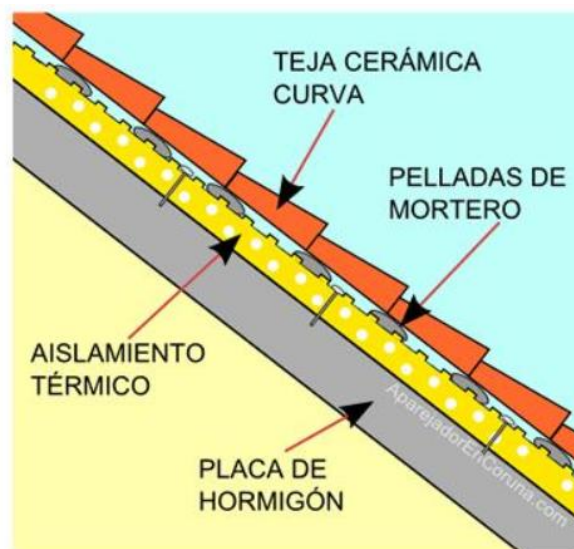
Aislamiento térmico en cubierta inclinada. Fuente: (Aparej, 2021)
